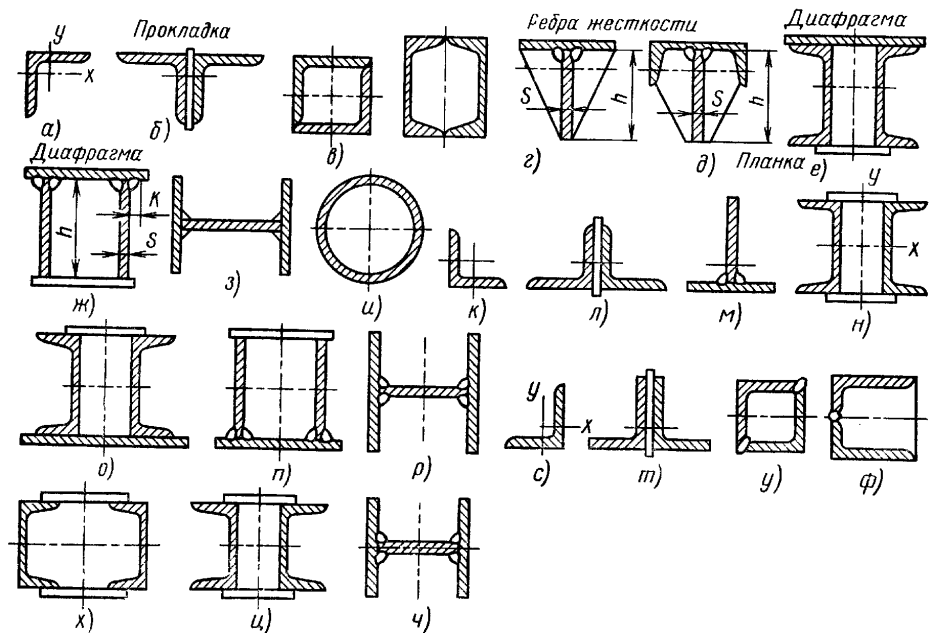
Типы поперечных сечений стержней ферм: а—и — сжатые пояса; к—р — растянутые пояса; с—ч — раскосы стоек
